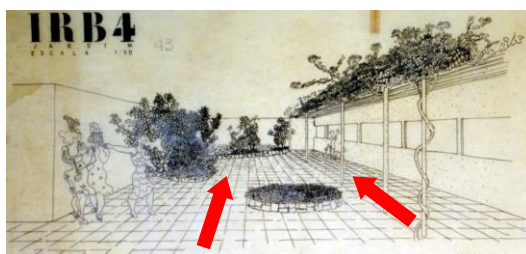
Perspectiva de la terraza-jardín del IRB con las aperturas en la zona sur.
